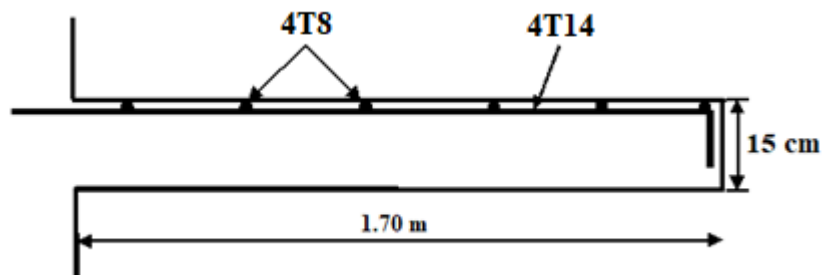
Schéma de ferrailage du porte à faux (terrasse)
